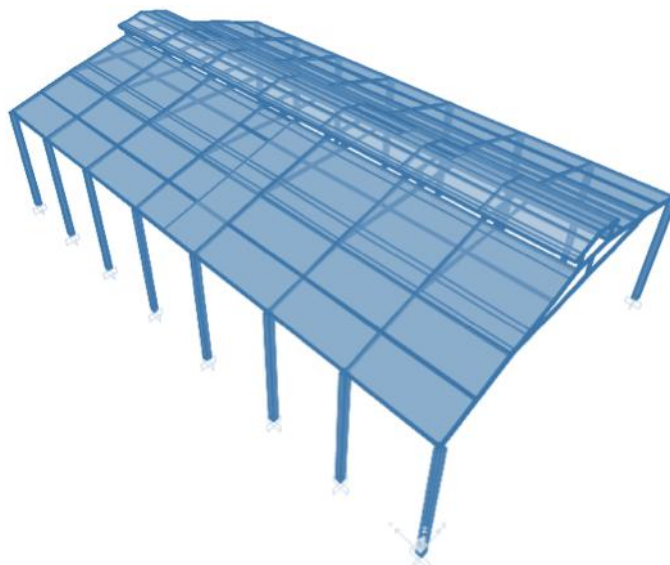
Modelo estructural de caso 1: colapso de estructura metálica
